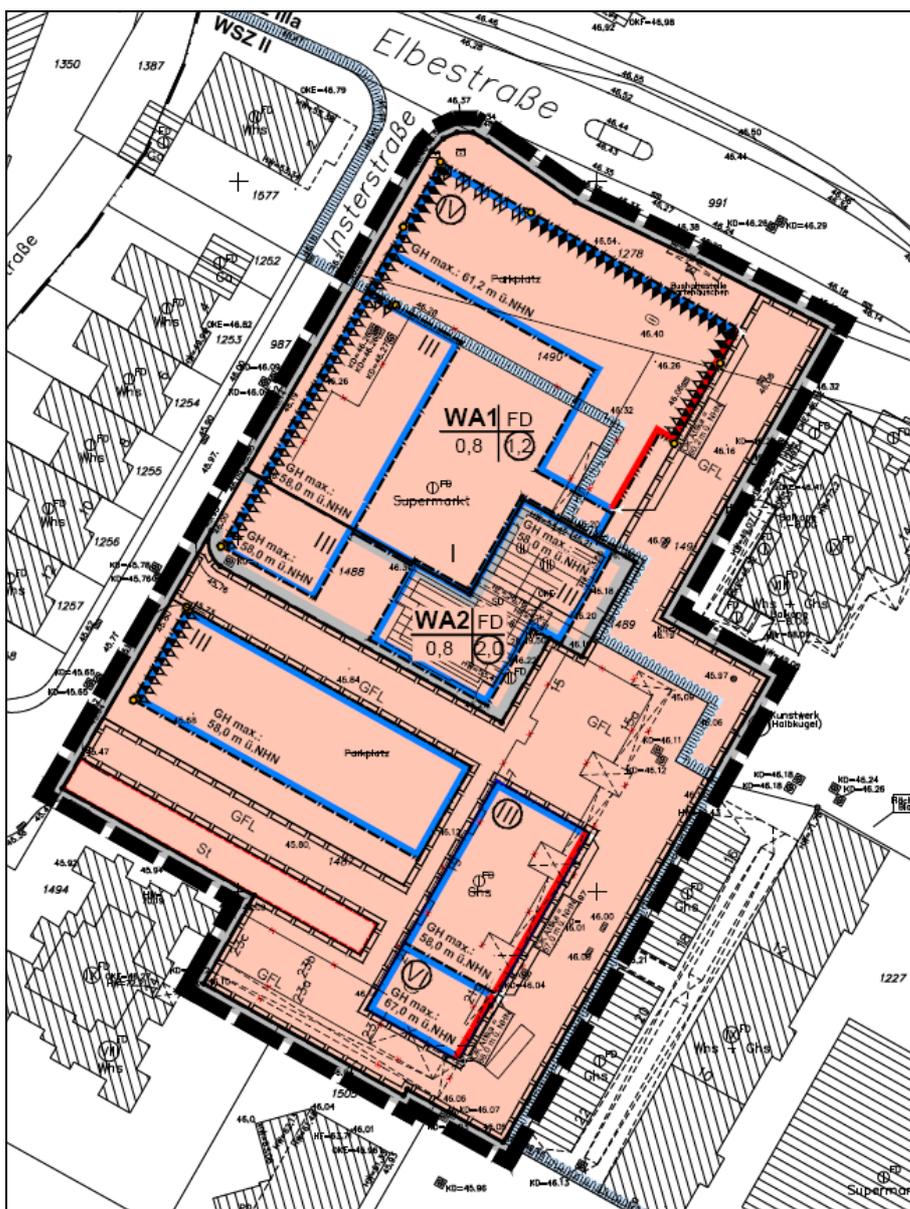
Ausschnitt aus dem Bebauungsplanentwurf
